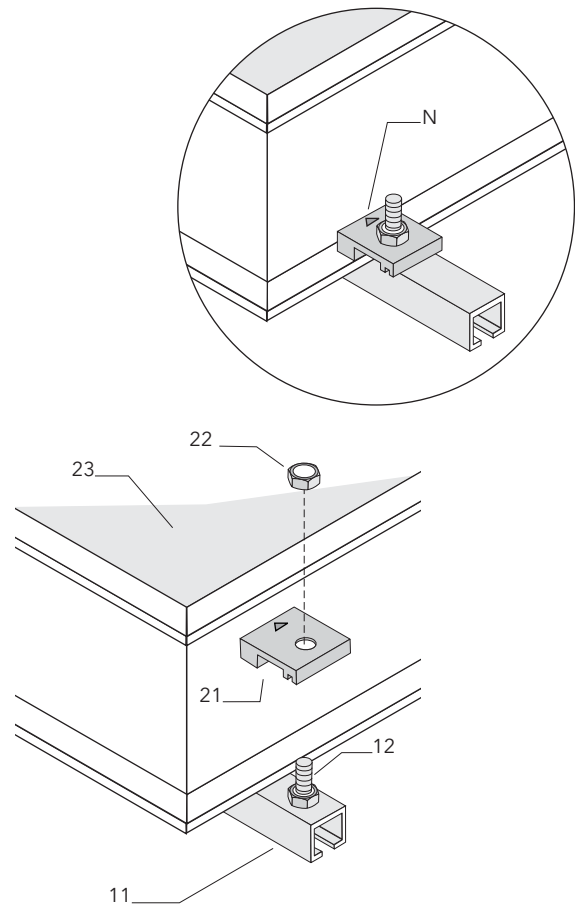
Befestigung des Kollektors auf den Montageschienen - die Markierung auf den Befestigungsklemmen muss immer zum Kollektor zeigen; (11) Montageschiene; (12) Hammerkopfschraube; (21) Befestigungsklemme; (22) Schraubmutter M10; (23) Kollektor; (N) Das eingeprägte Dreieck muss immer zum Kollektorrahmen zeigen.
